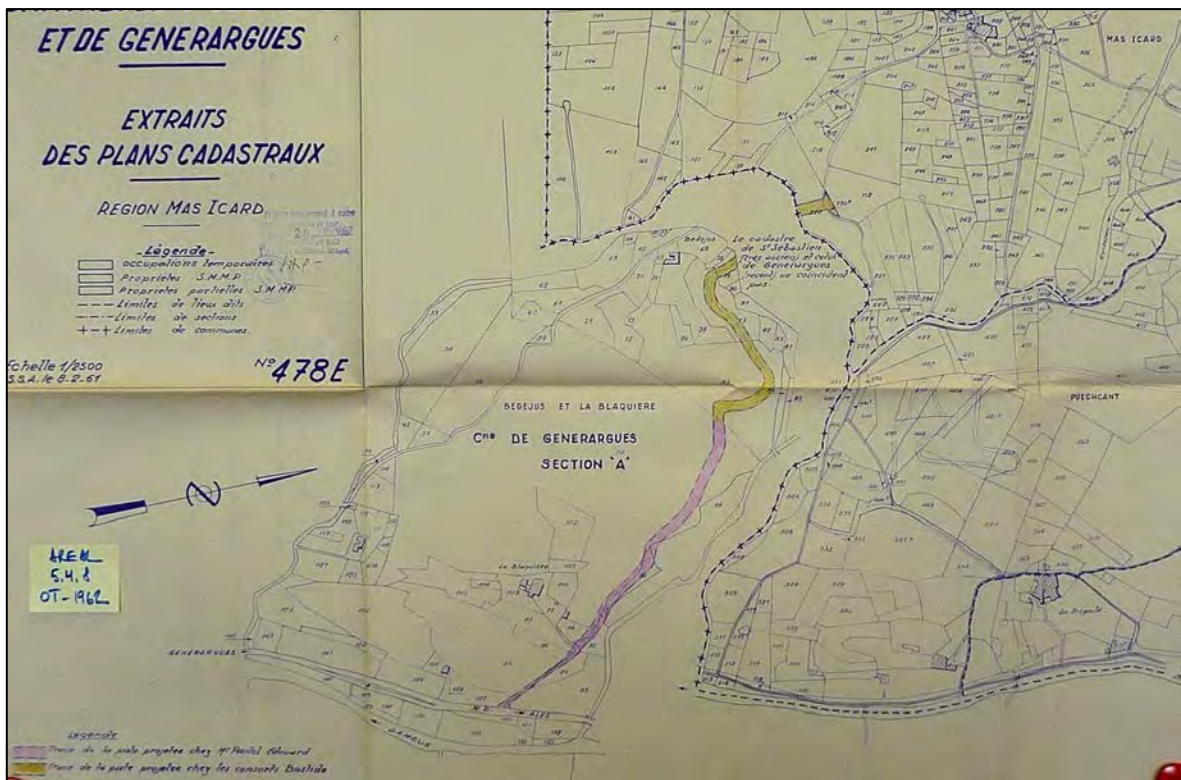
Plan de la piste d'accès projetée au Mas Icard (source : plan SSA de février 1961, archives DREAL 5.4.8)
